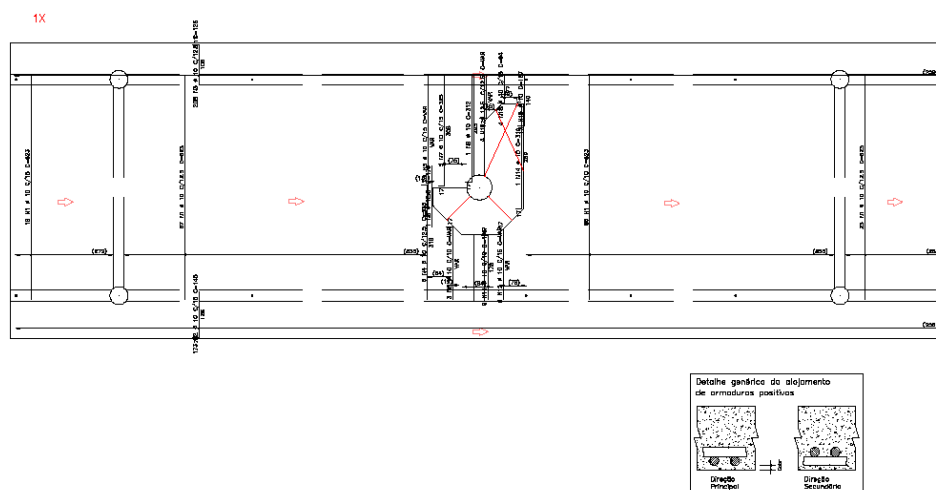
1º pavimento: armadura positiva secundária. Fonte: AUTOR (2017).
